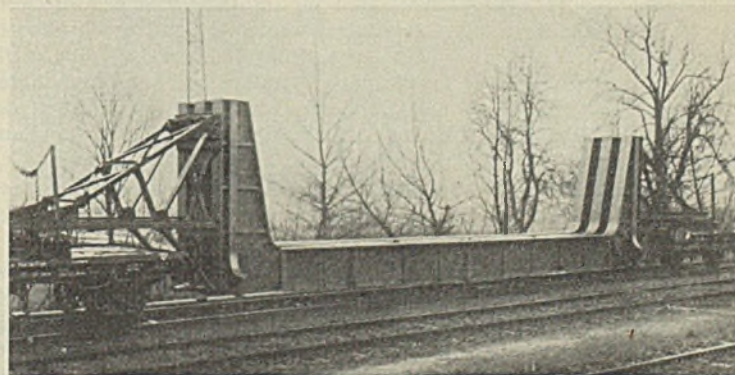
Beförderung der geschweißten Rahmen für den in Bild 1 gezeigten Überbau.
